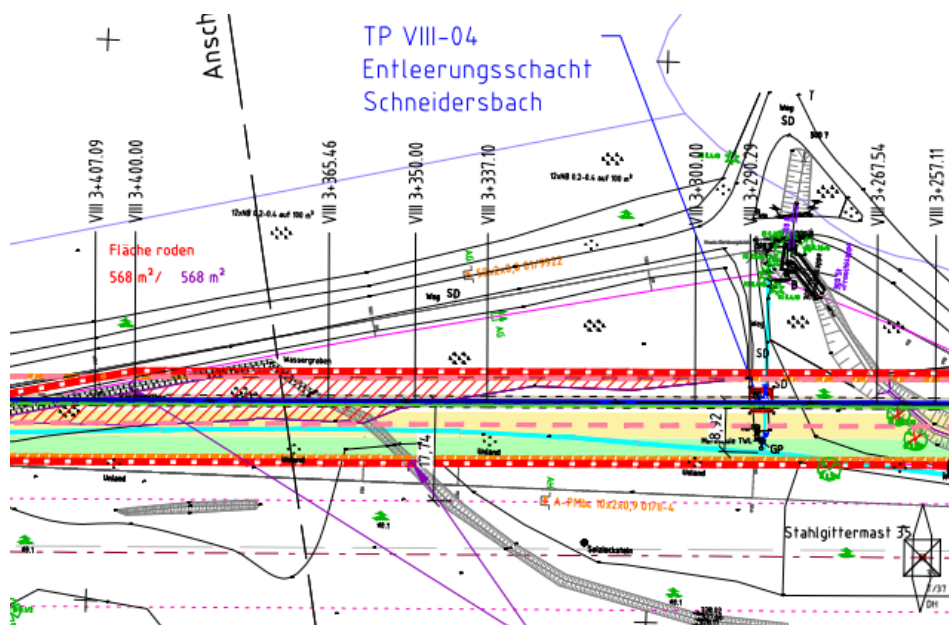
Ausschnitt aus dem Lageplan (Anlage 3.2-13)
